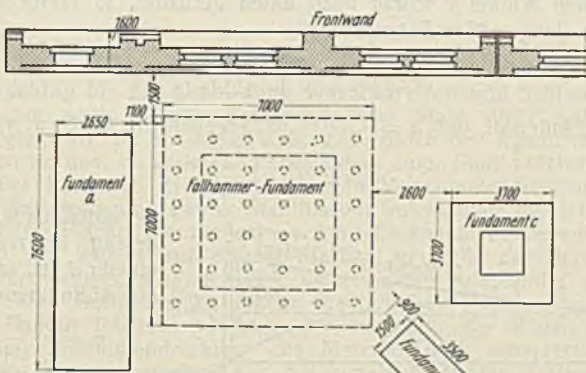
Grundriß mit den vorhandenen Fundamenten und dem vorgesehenen Fallhammerfundament.
